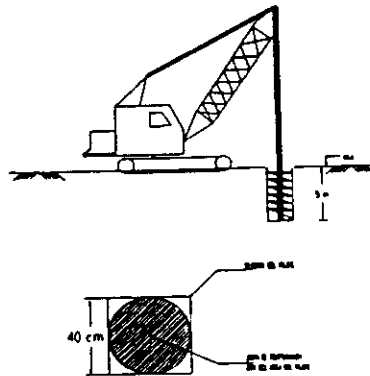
PERFORACIÓN PREVIA DE PILOTES
